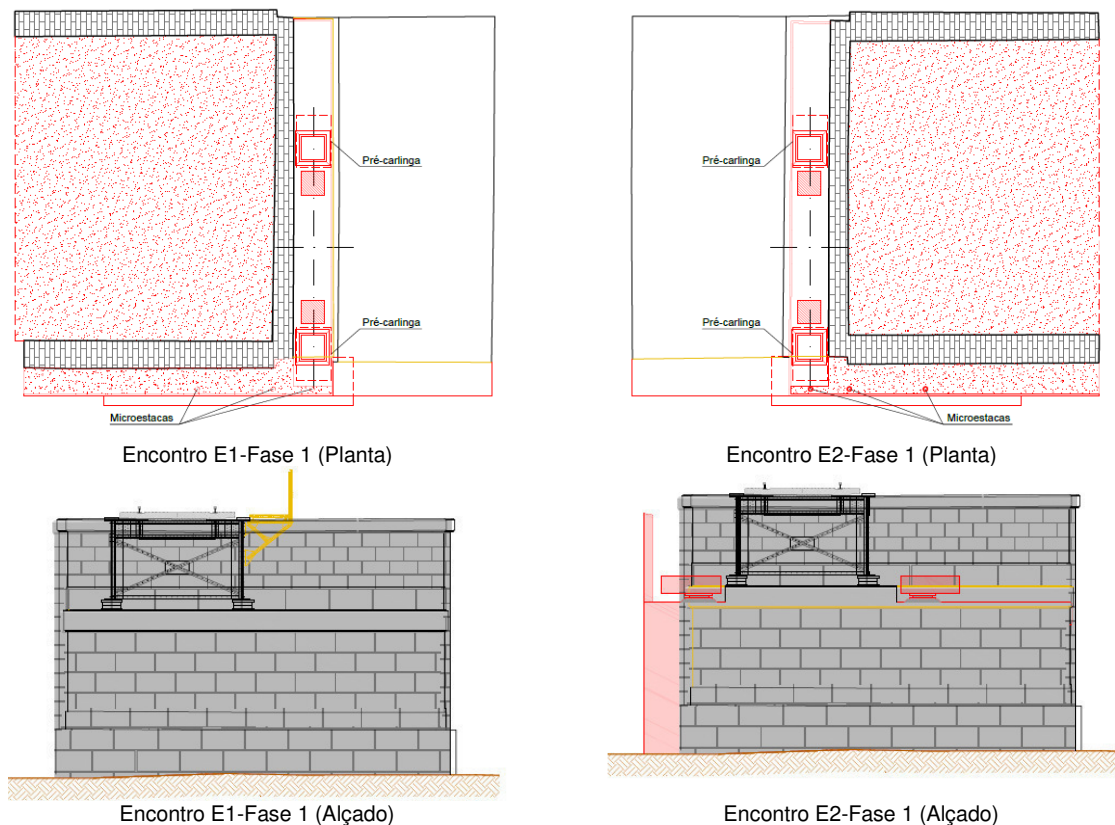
Intervenção nos encontros ponte do Caiola [42]
